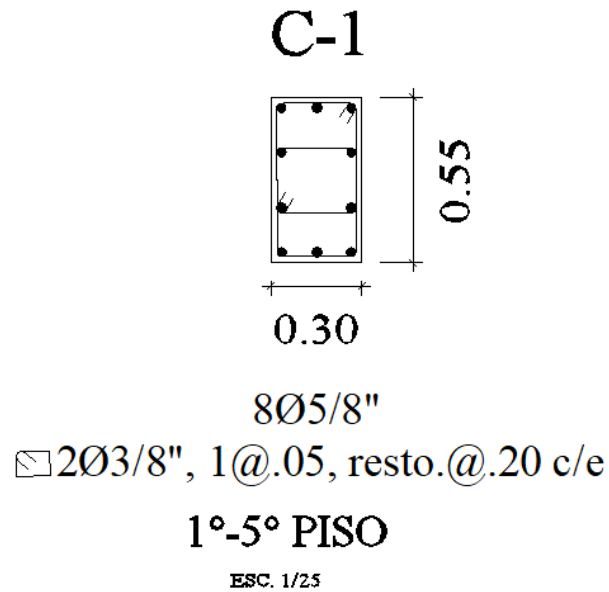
Armado del acero de refuerzo para los elementos columnas. Elaborado por el investigador.
